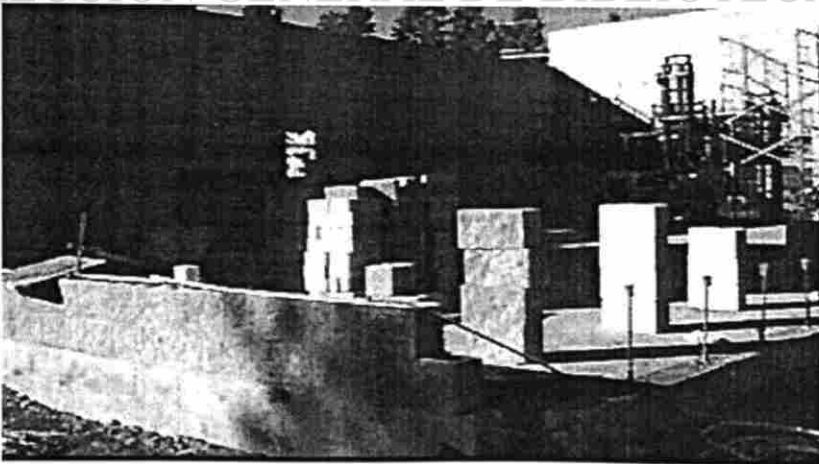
Construcción de un muro de mampostería sujeto a flexión.
